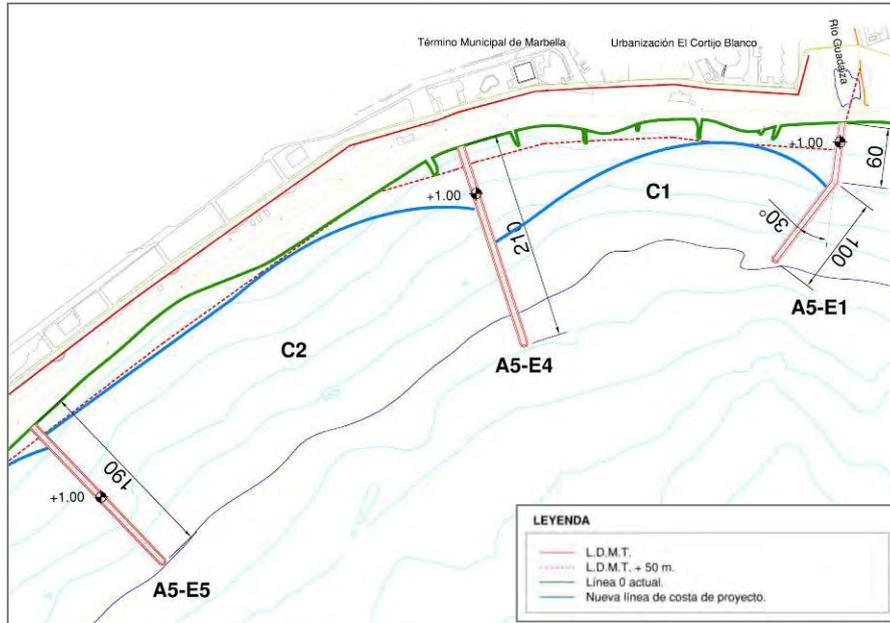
Planta Alternativa 5. Celdas C1-C2.
